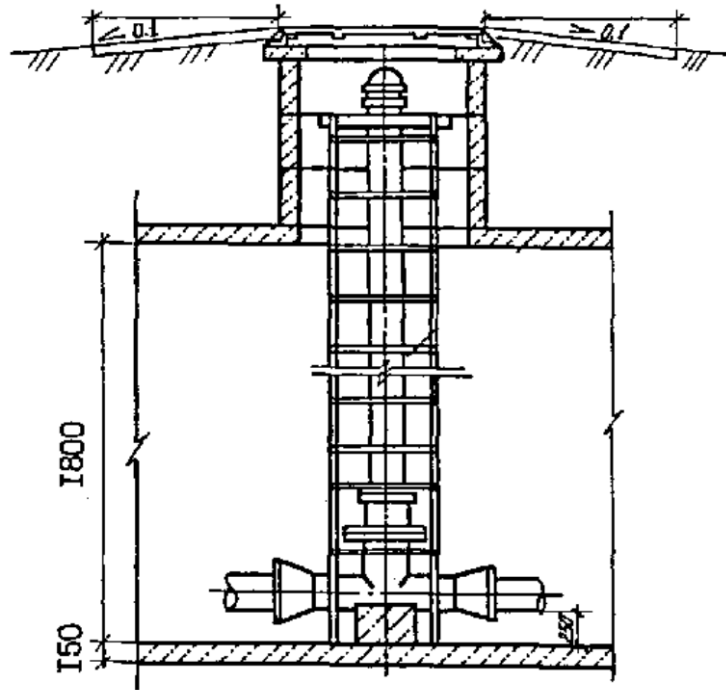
Схема установки пожарного гидранта на водопроводной сети
